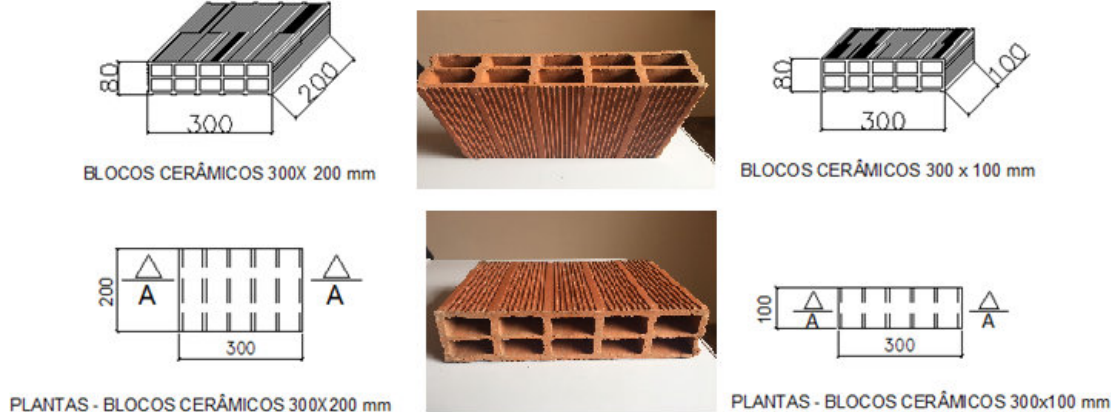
Bloco cerâmico utilizado para edificações habitacionais de até 05 pavimentos
